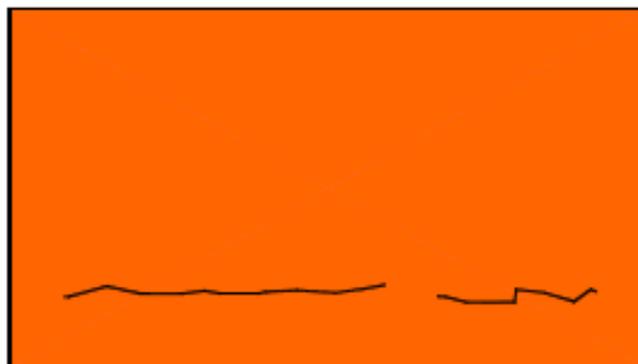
Fissuras horizontais na alvenaria provenientes da atuação excessiva de cargas.
